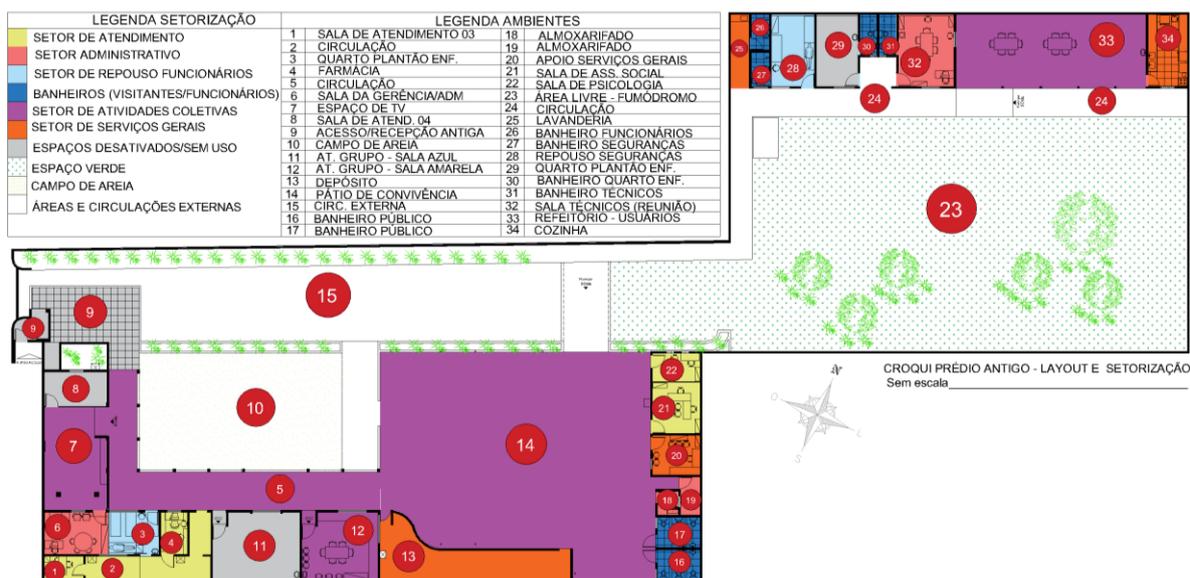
Planta-baixa do primeiro prédio do CAPSad-A -
